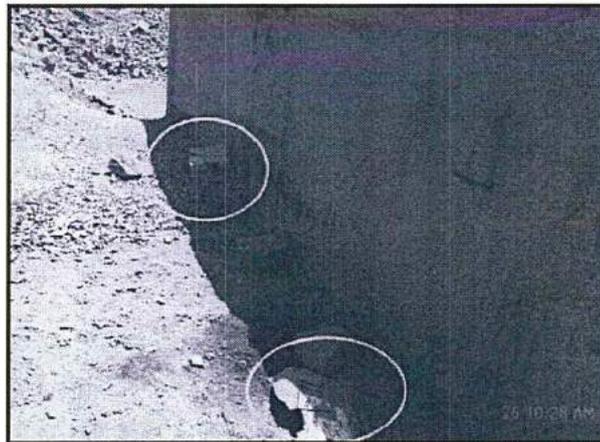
del Informe de Supervisión: En el Nivel +295 de Mina Condestable. Zona posterior de la losa de concreto. Se observan estructuras metálicas.
